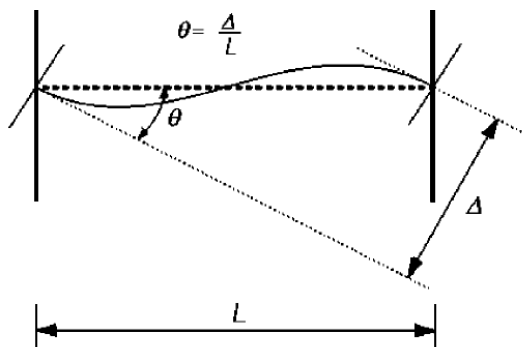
钢筋混凝土连梁的相对变形角计算示意图
